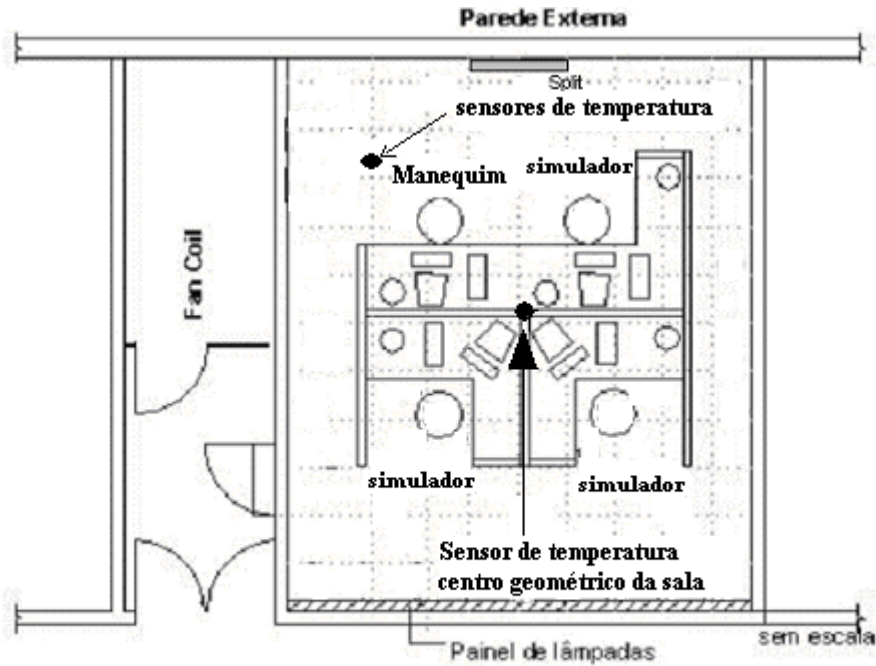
Planta baixa da câmara de testes e disposição do manequim e simuladores.
